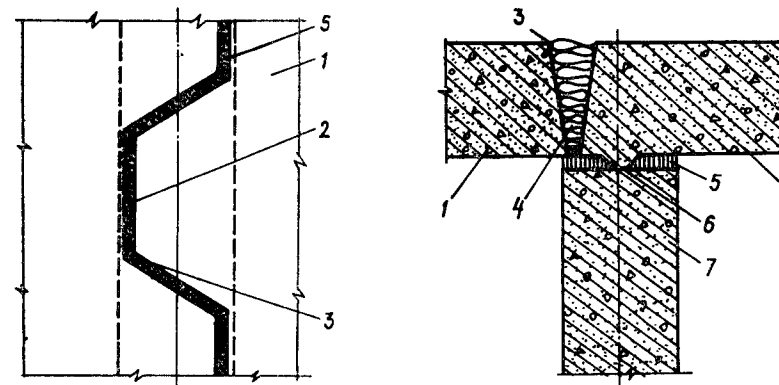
Сопряжение панелей перекрытий и стен без эксцентриситета:
